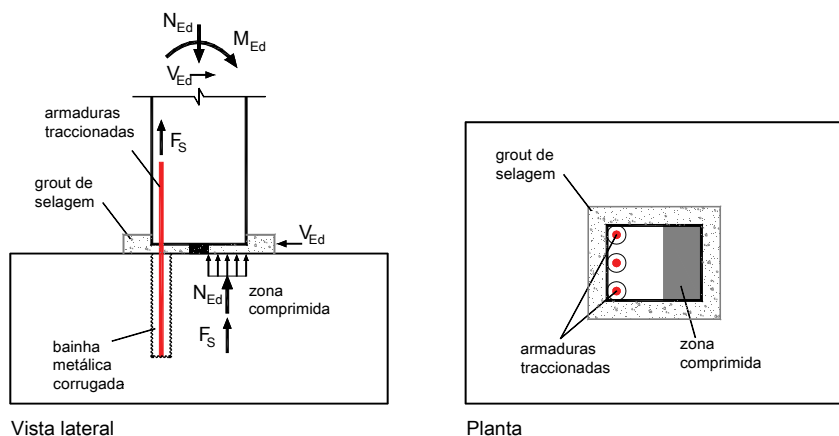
Ligação pilar-fundação com armaduras salientes do pilar - esquema construtivo e forças na ligação.
